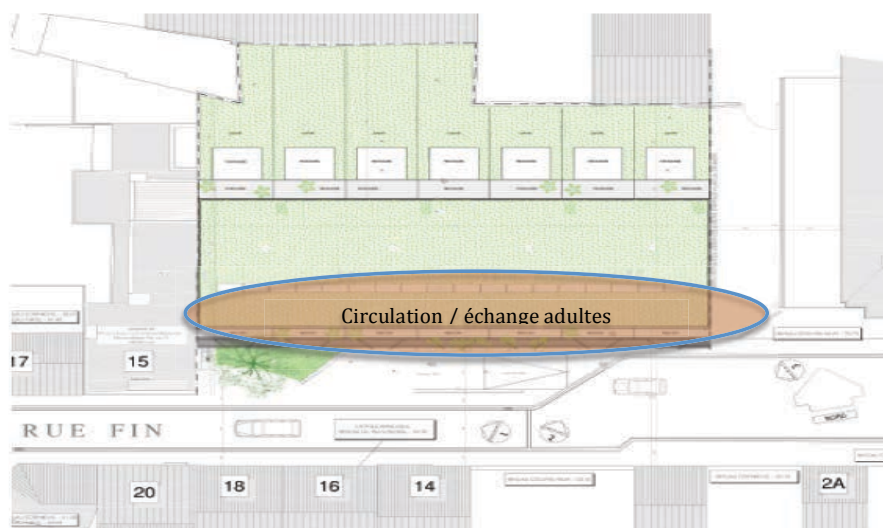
Plan masse, opération « la rue Fin ». Plan concepteur.
